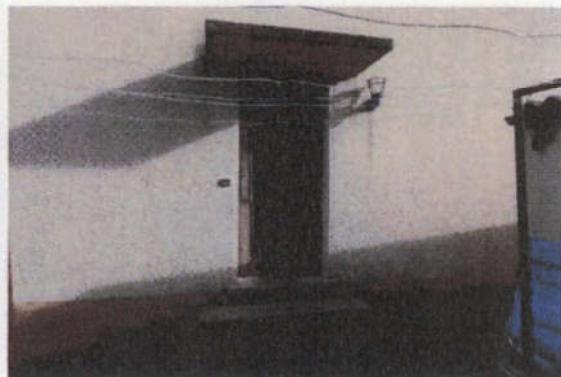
Wohnung Nr. 1 im EG - Südfassade
